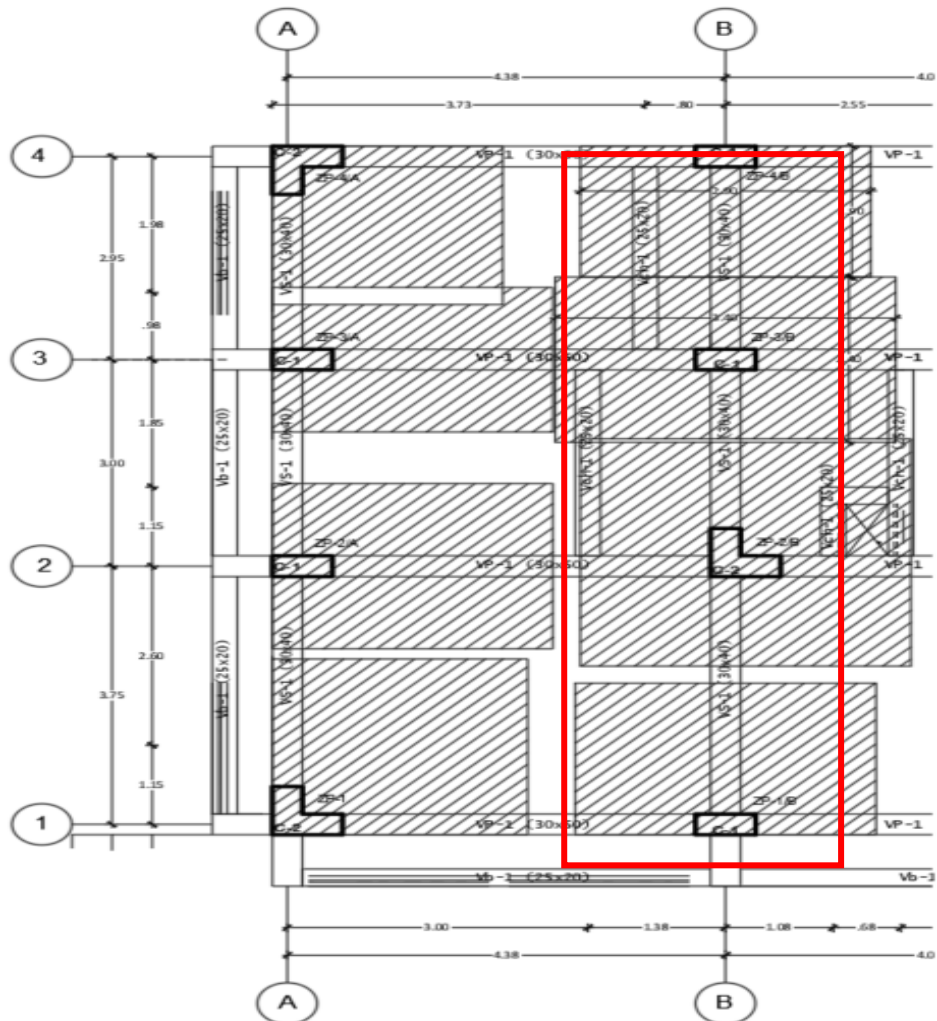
Ejemplo de zapatas aisladas superpuestas ejes A y B. Elaborada por la autora.
